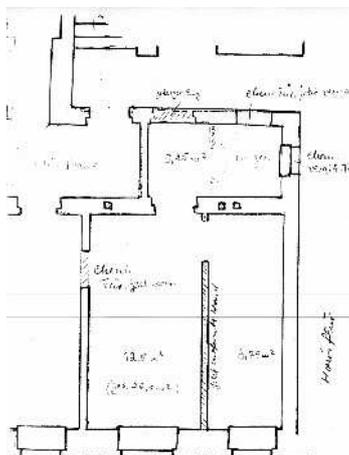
Grundriss der Wohn- und Atelierräume von Kirchner in Dresden, Berliner Strasse 80, Zeichnung von Bernd Hünlich, Dresden
